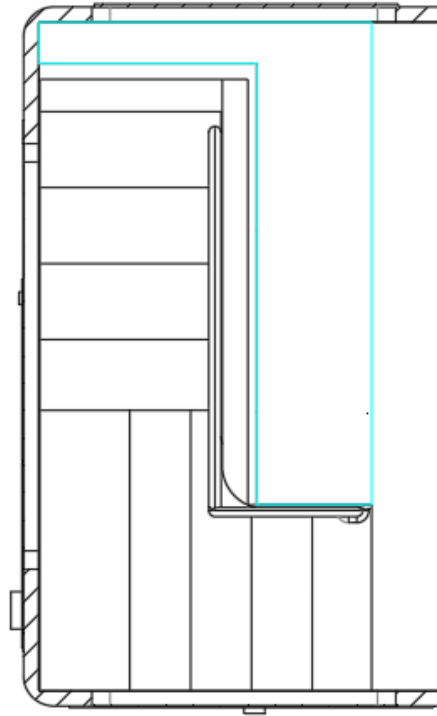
Espacio para colocación de elementos de instalación solar. Fuente propia
